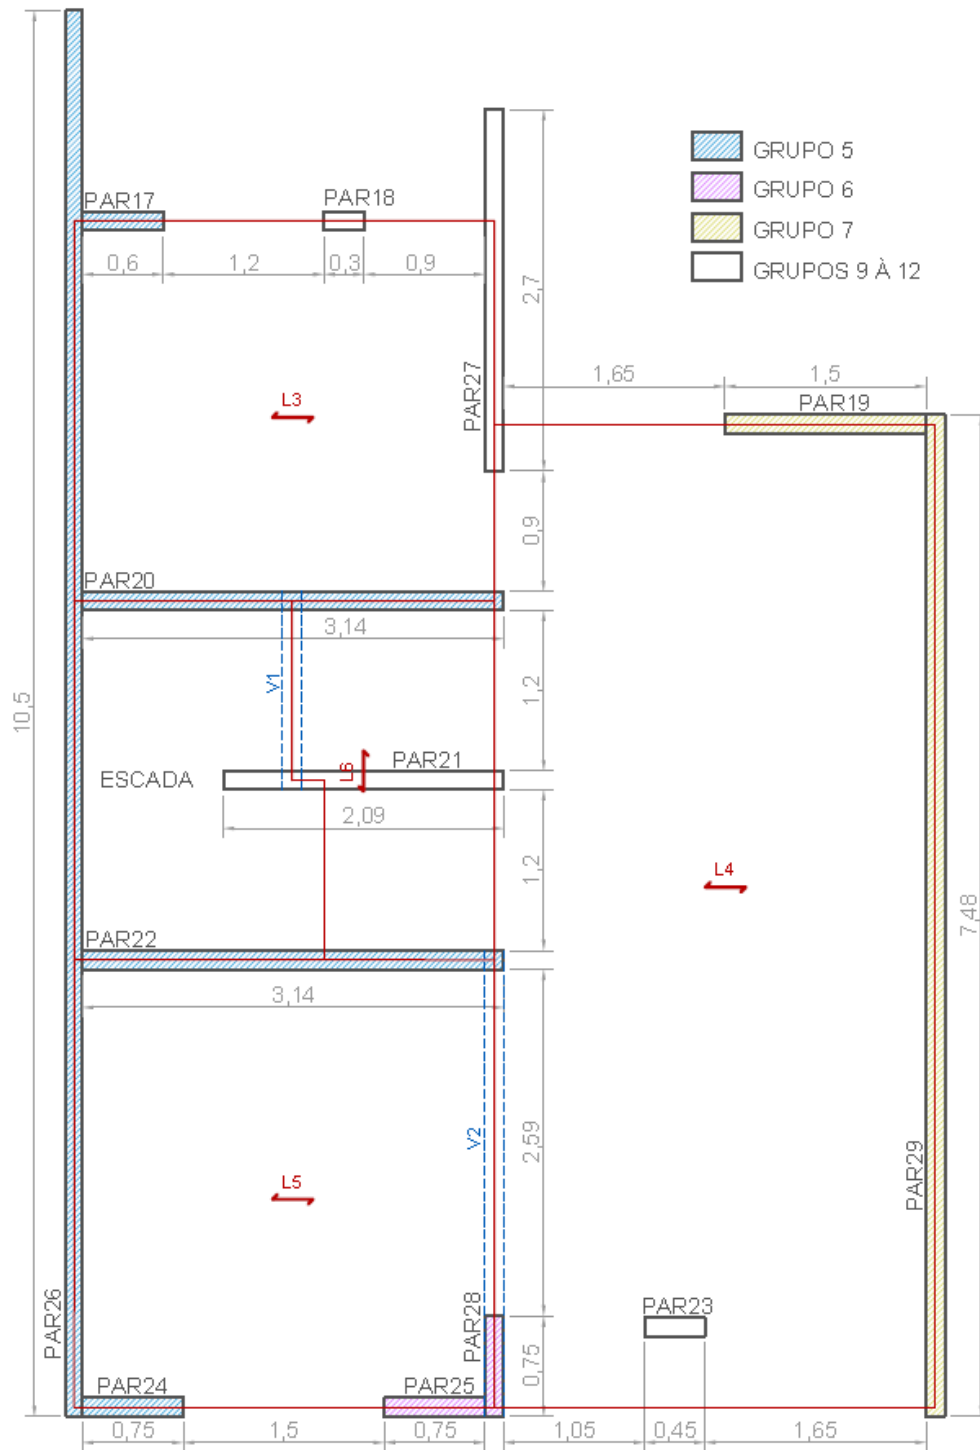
4 Pavimento térreo: definição dos elementos estruturais.
